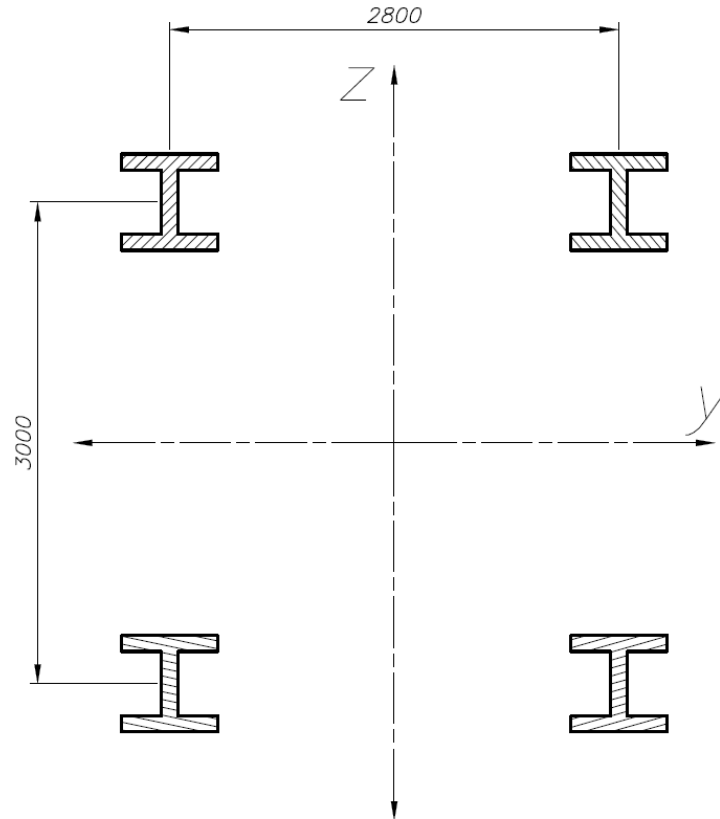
Sección transversal de la viga principal de la galería metálica con sus dimensiones en mm.
